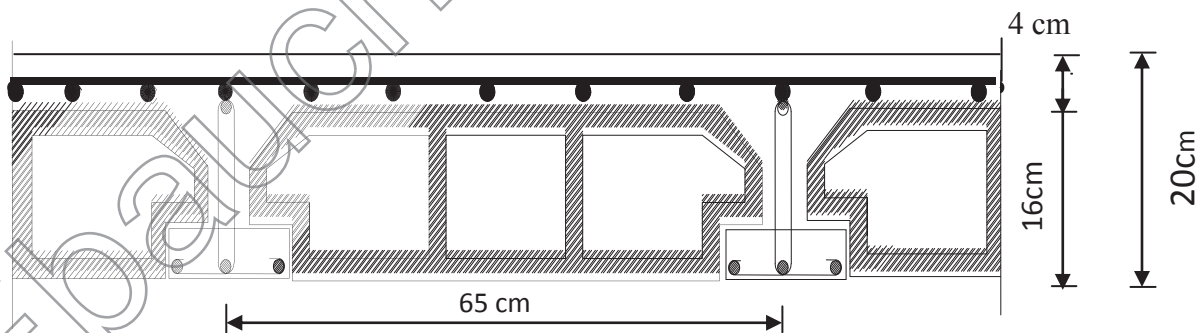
Coupe transversale d'un plancher en corps creux.
